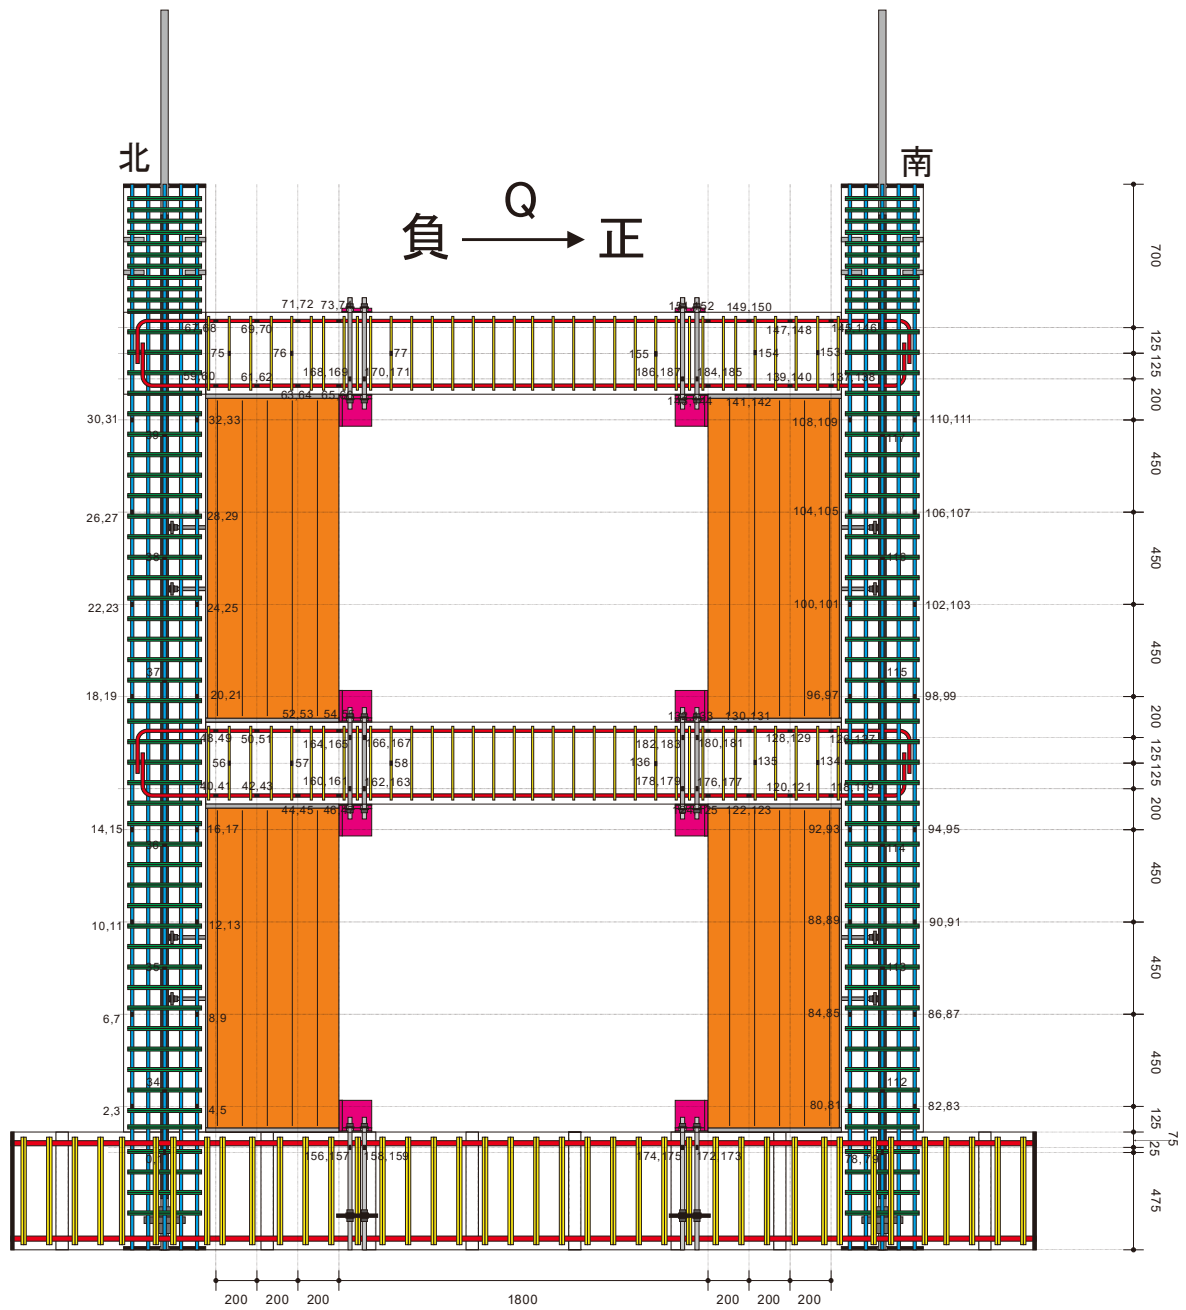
試験体 B の柱主筋、帯筋、寸切りボルトに貼付したひずみゲージの位置 (単位 : mm)
